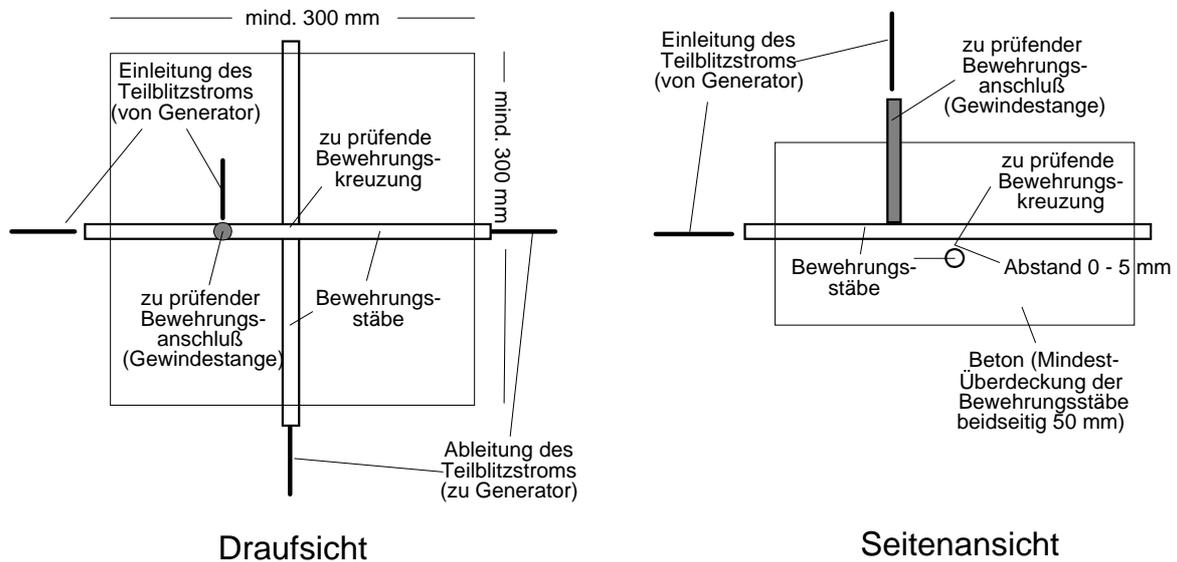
Prüfling Typ A: Quadratischer Betonkörper mit einer Bewehrungsstab-Kreuzung.
